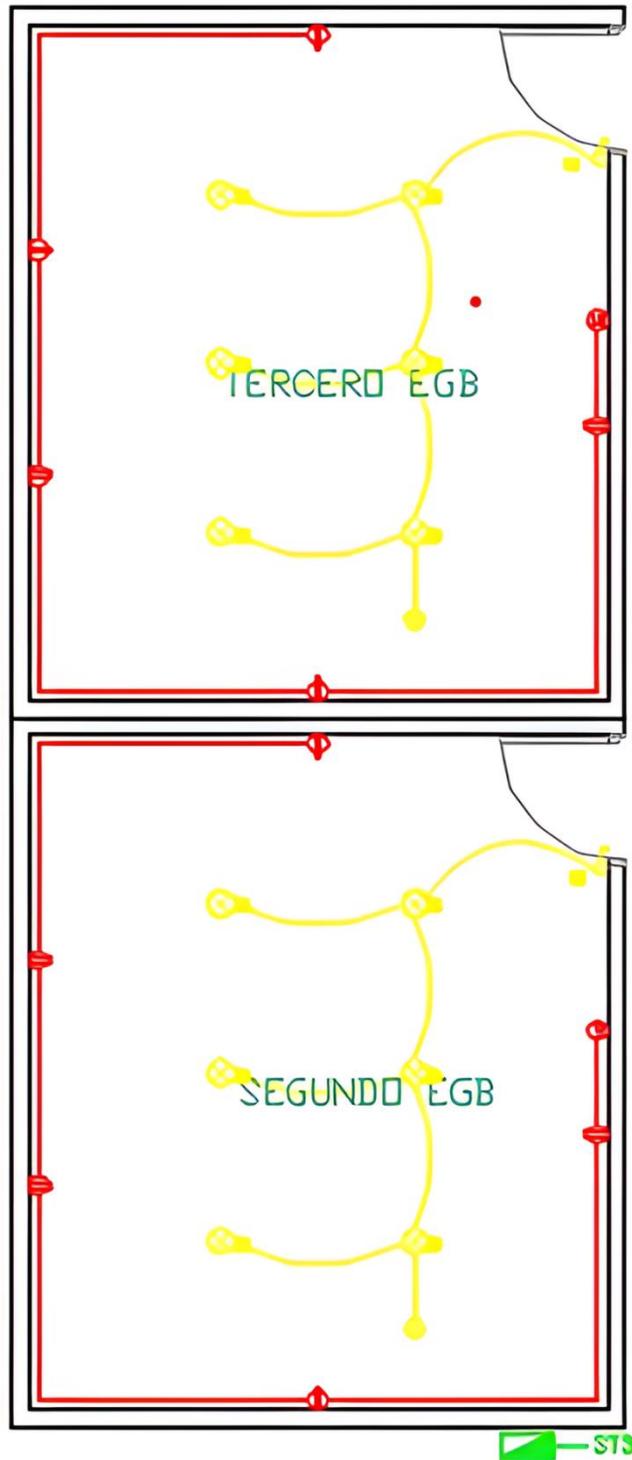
Plano de Rediseño de 2do- 3ro EGB.
